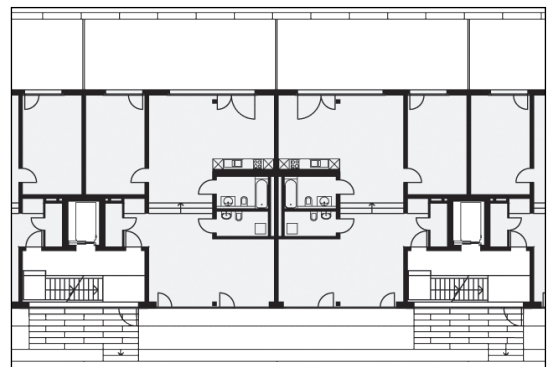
Grundriss Wohnstudios Octavo,
